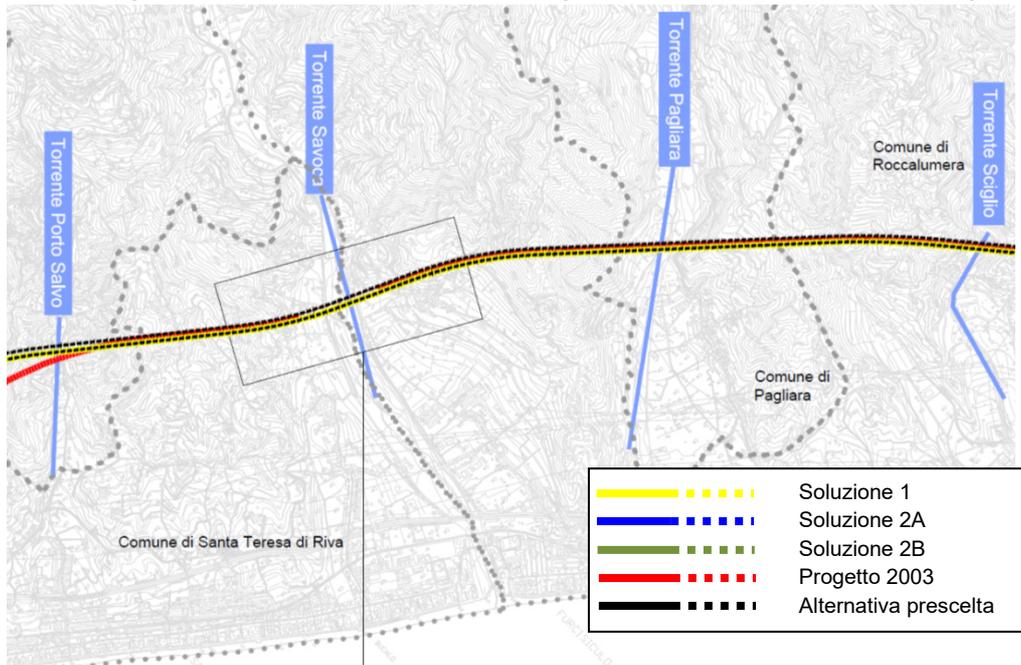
Tavolo Tecnico Variante Altimetrica Furci S. - Santa Teresa di Riva. Planimetria
